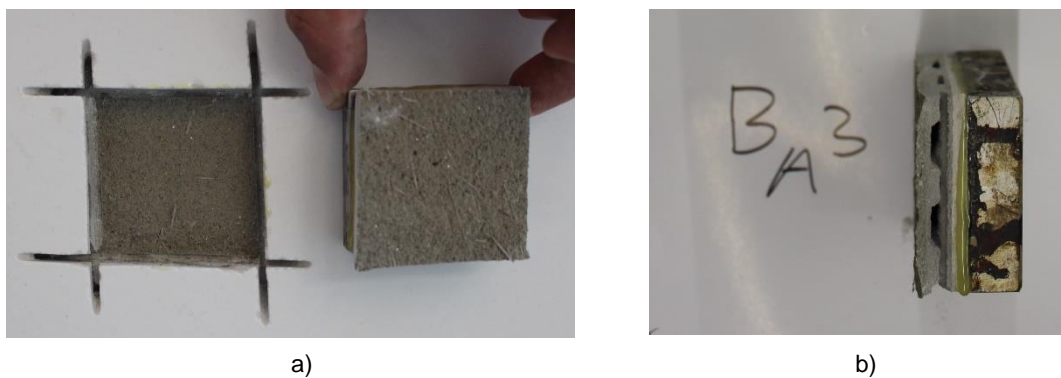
Ensaio de aderência Ba₃: a) Vista de frente; b) Vista em perfil
